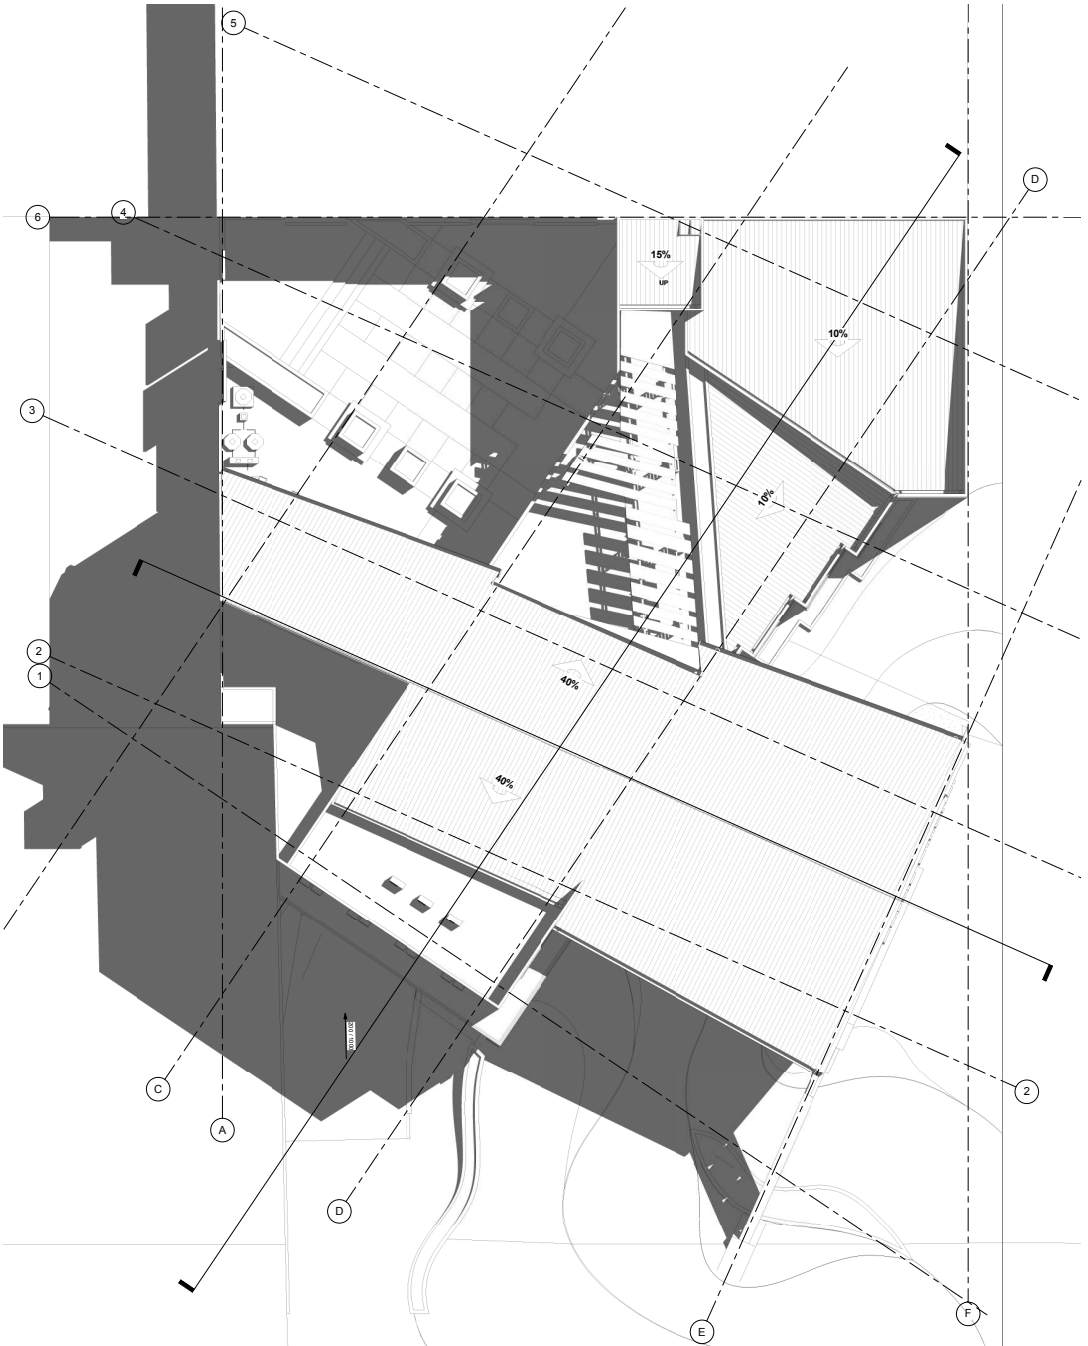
Planta Arquitectónica Nivel III. Fuente: propia
